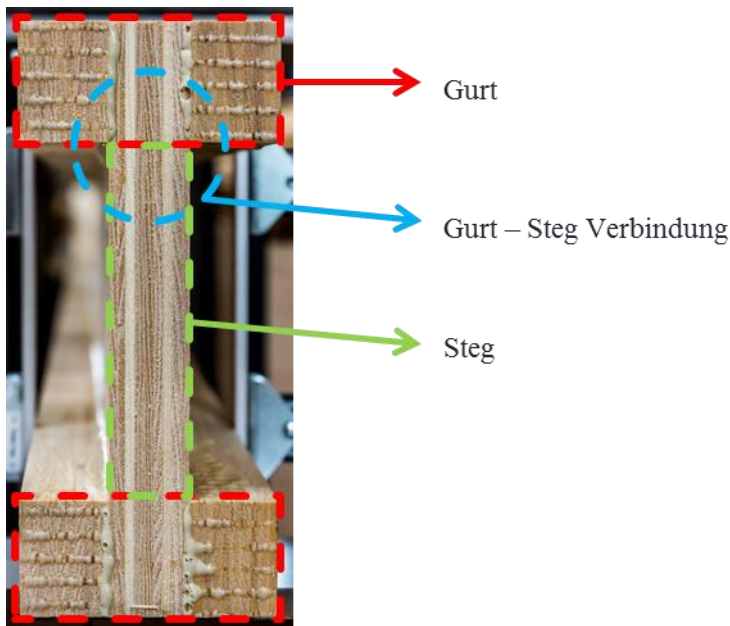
Elemente eines Trägers mit I-förmigem Querschnitt
